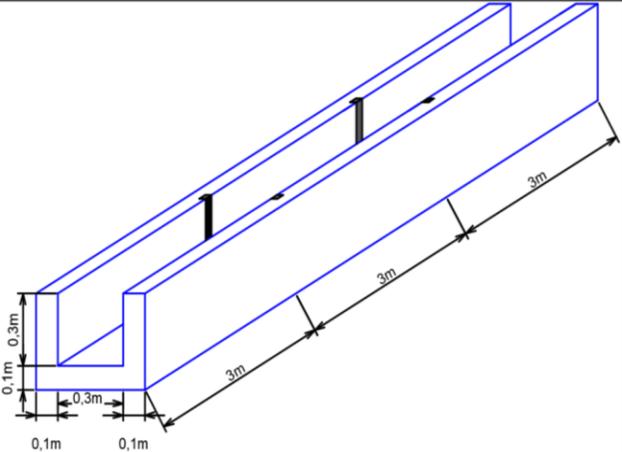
Presencia de fisuras en el muro del canal.
